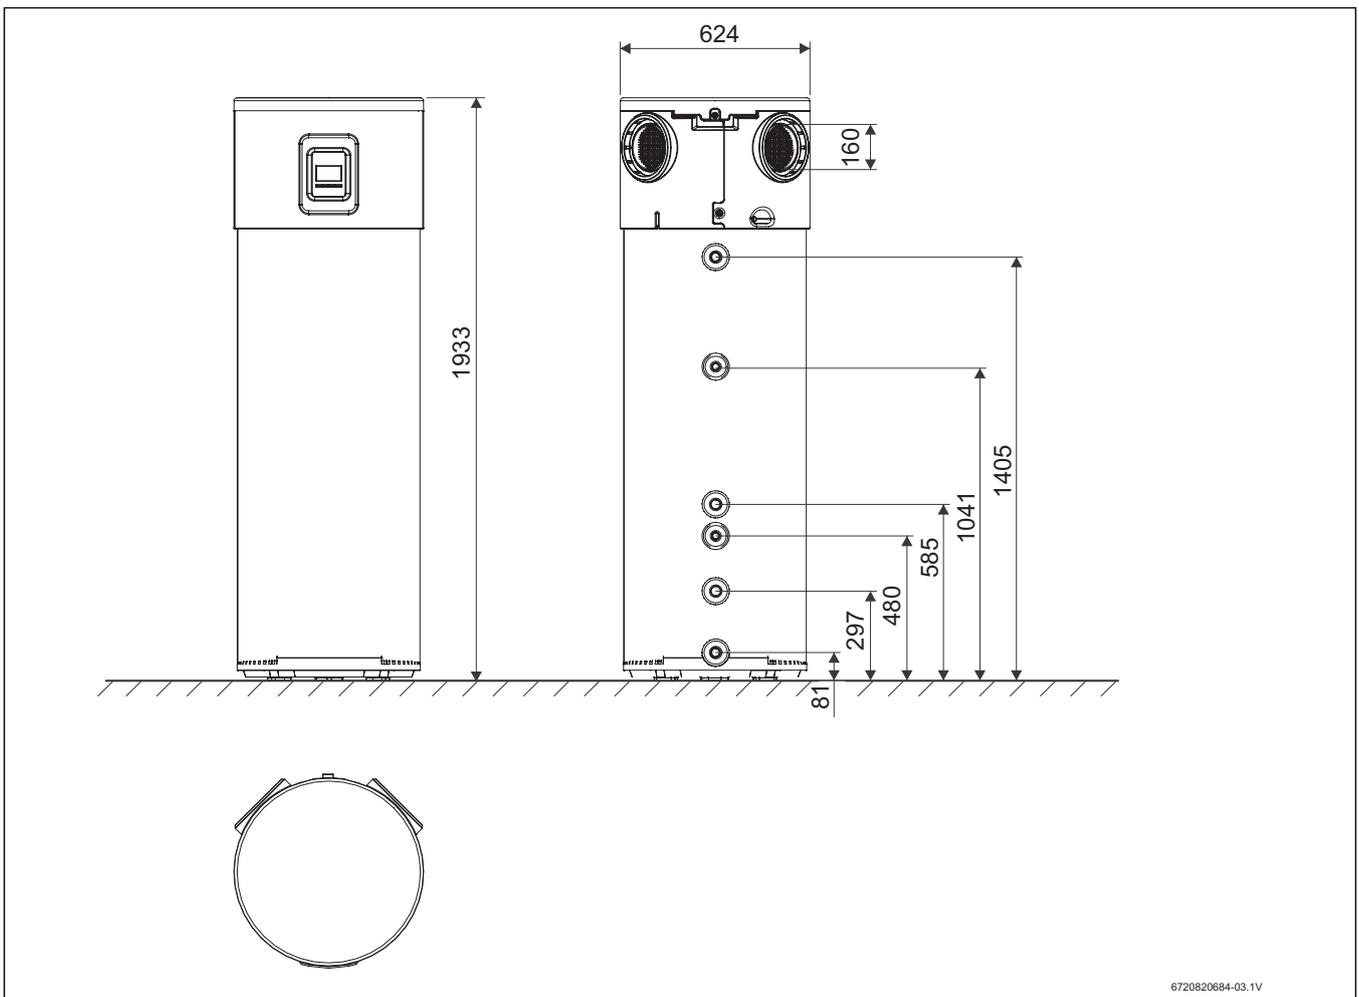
Abmessungen Compress 4000 DW (Maße in mm)
